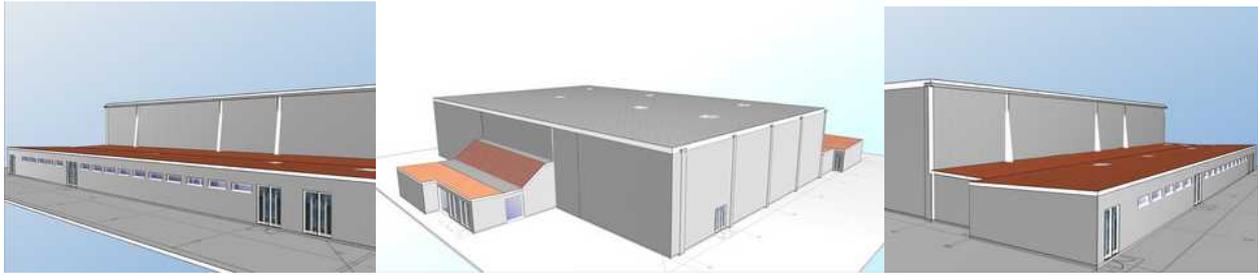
Vereinfachte Darstellung des Gebäudes als wärmeübertragende und möglichst luftdichte Umfassungsfläche
